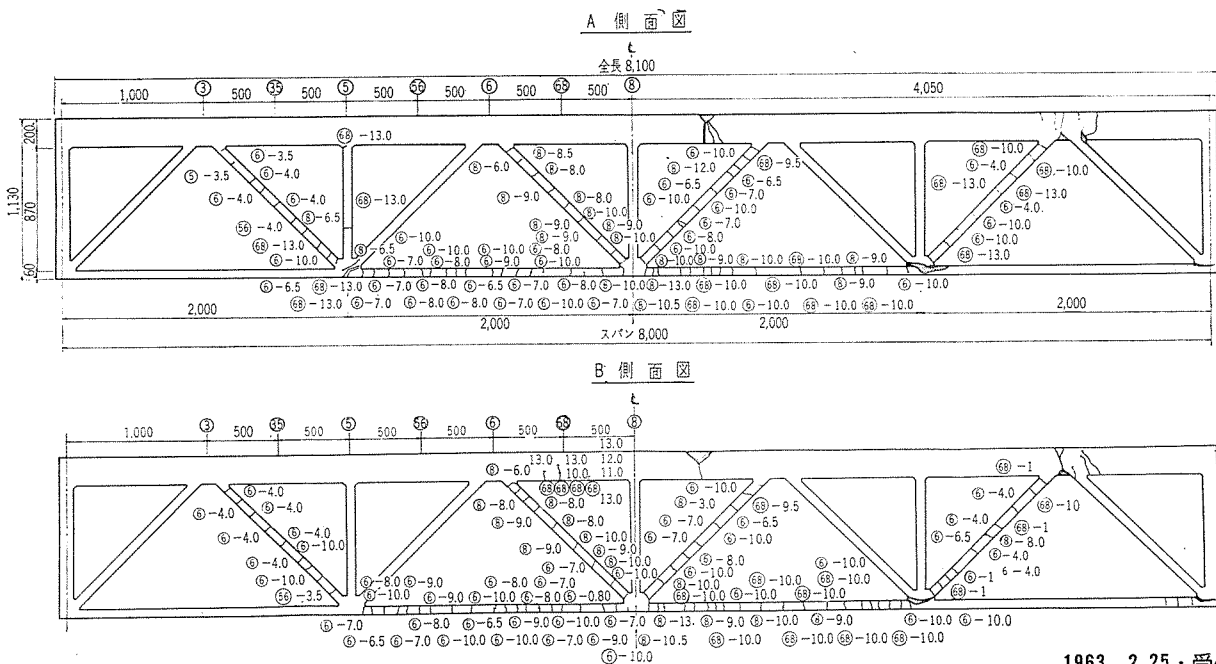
プレストレスト コンクリート供試りひびわれ図
